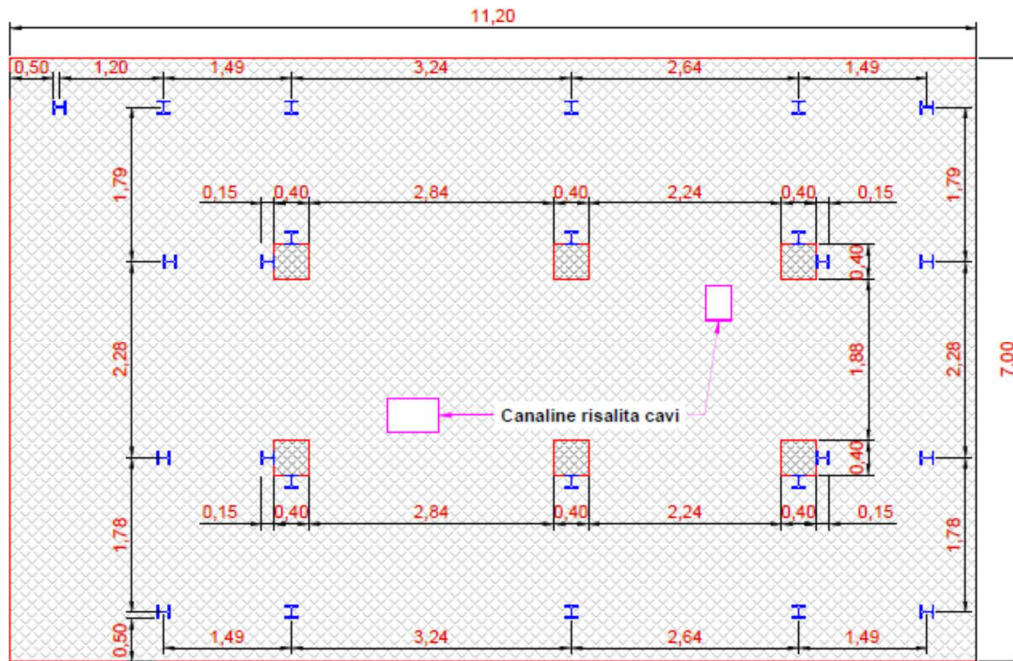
Vista planimetrica delle strutture portanti di Fondazione – platea e pilastri in c.a.
